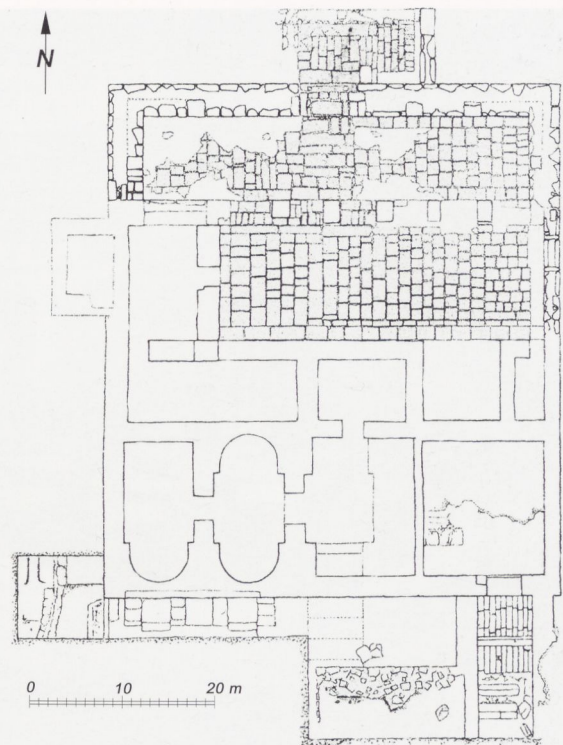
Androna. Grundriss des frühislamischen Bades.
